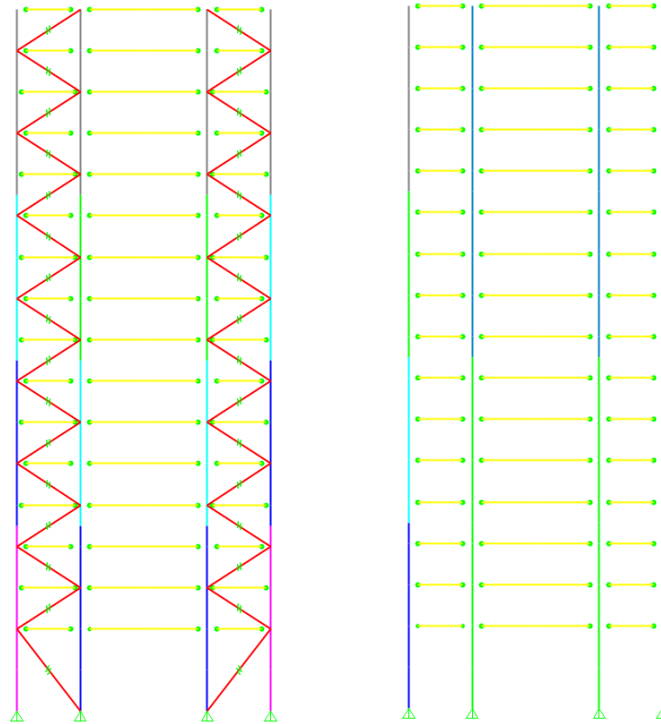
d Elevación “tipo” exterior (derecha) y corte “tipo” interior (izquierda)
